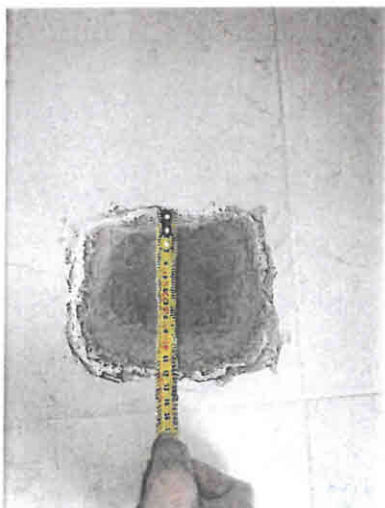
e 9 - Observou-se, à vista, revestimento em azulejo cerâmico, reboco e tijolo.
